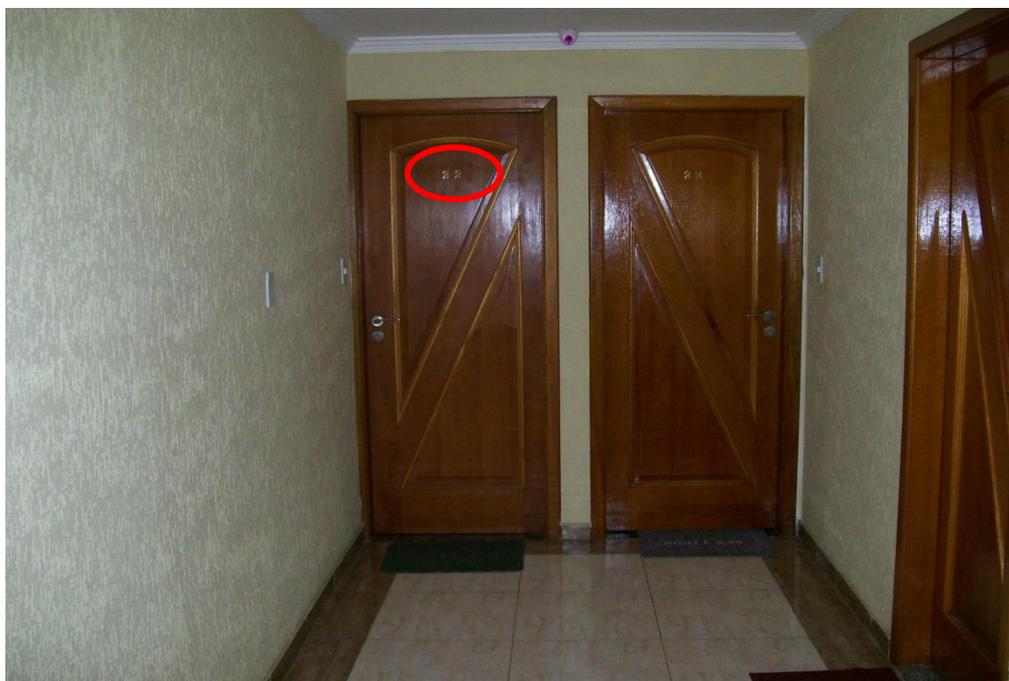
Outra vista complementa a FOTO anterior, visando a notação do tipo construtivo deste prédio pluri-habitacional formado de 02 (dois) blocos não contíguos, denominado Cond. Res. ERICK LUCAS E WESLEY.
